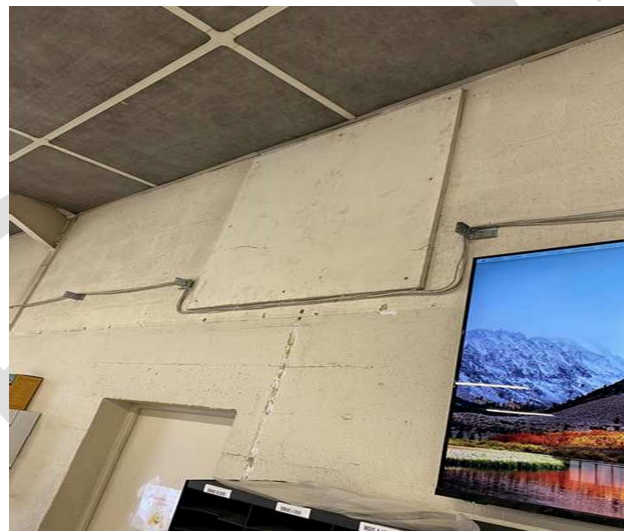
Trappe en bois dans le mur séparatif des bureaux
